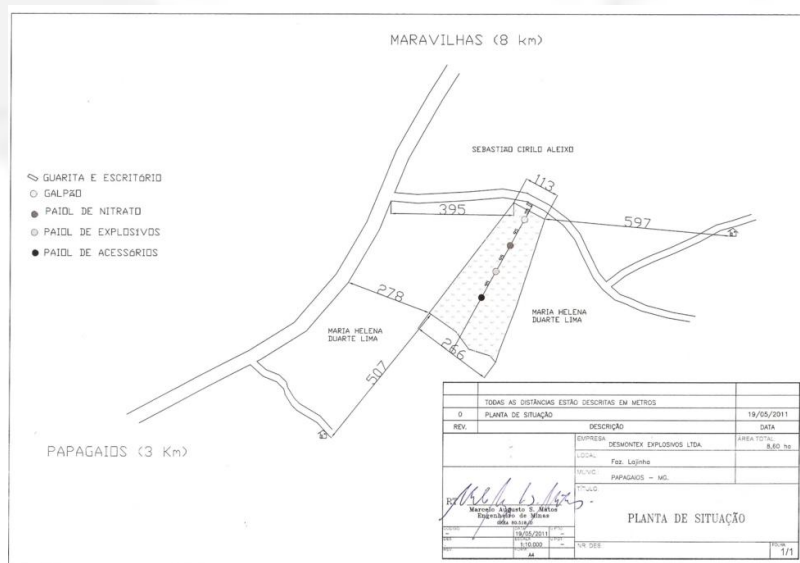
Planta de situação do empreendimento. Fonte: RCA, 2013.
